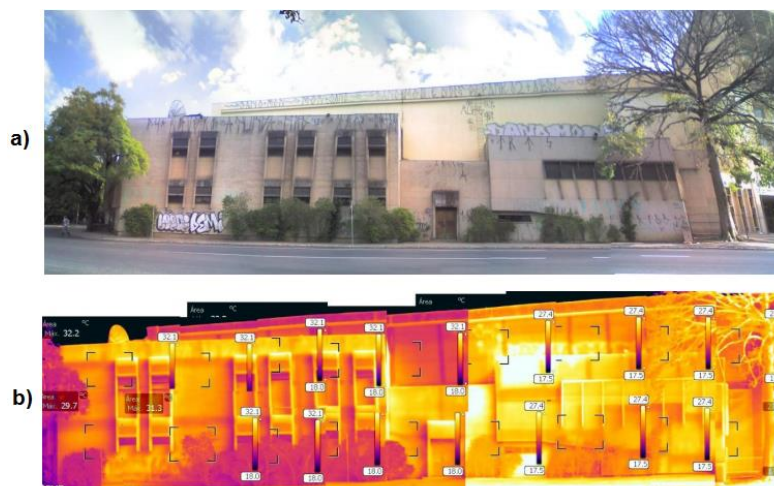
a) Levantamento visual da fachada Nordeste. b) Levantamento termográfico da fachada Nordeste.
